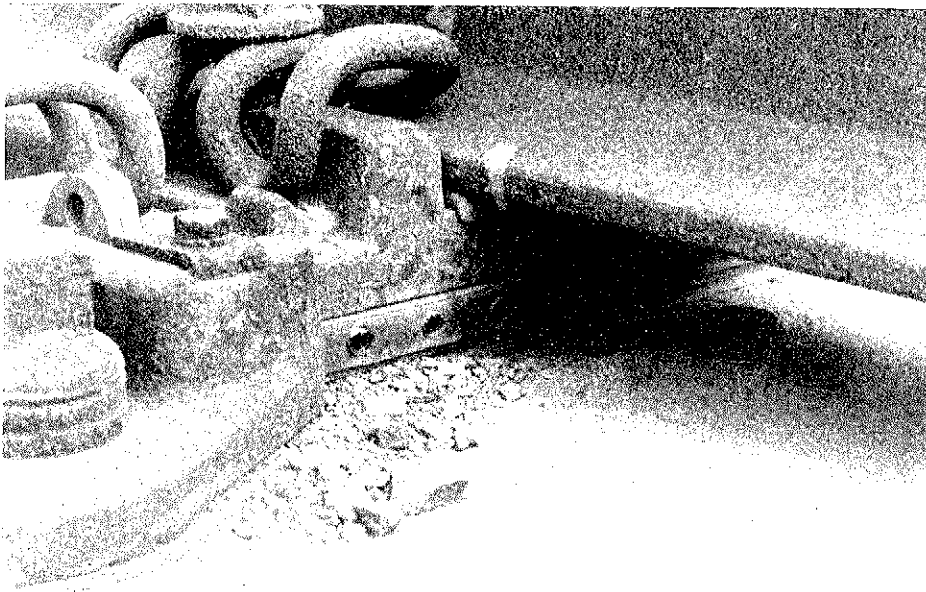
Zapata Vialast para fijación de raíles sobre hormigón.
